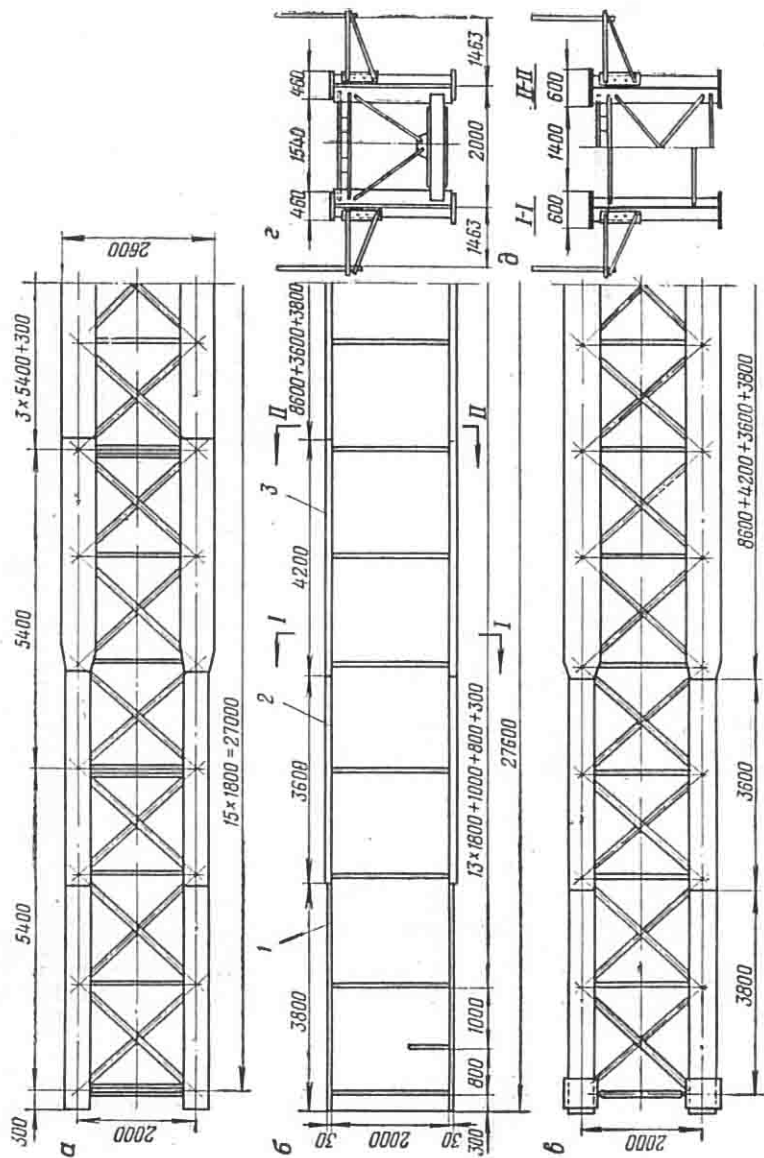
Цельносварное пролетное строение длиной 27 м со сплошными балками:
